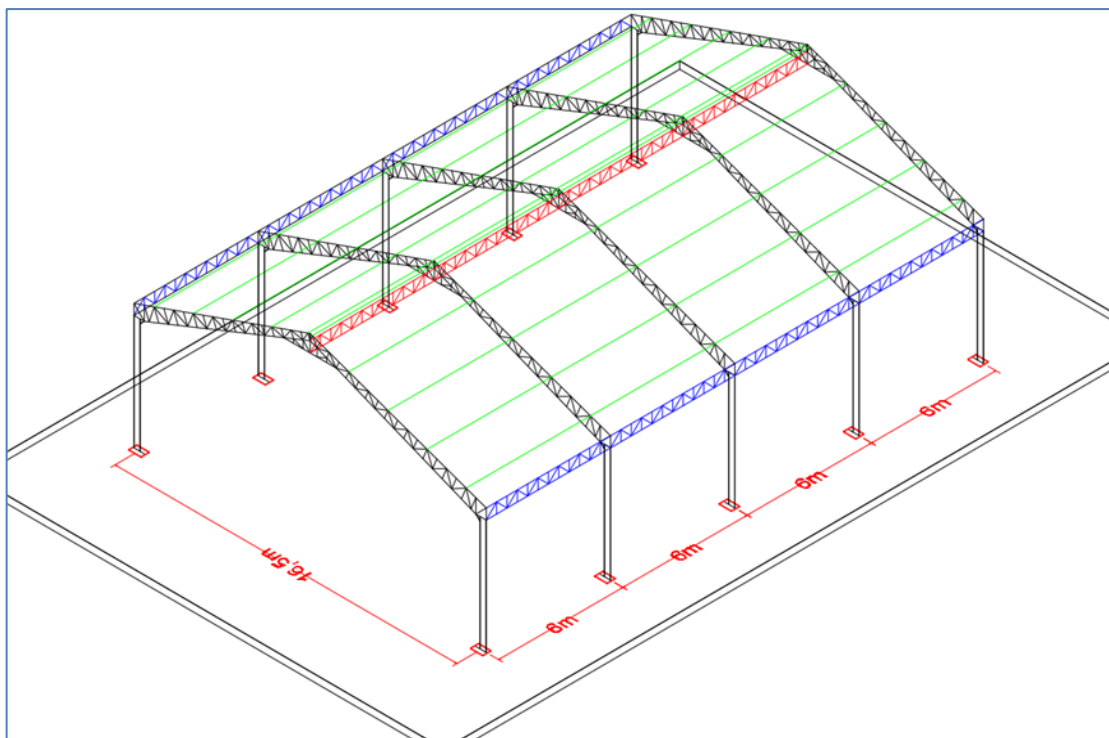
Geometría de la Cercha (Alternativa 2) – Perspectiva Columna Tipo HEB
